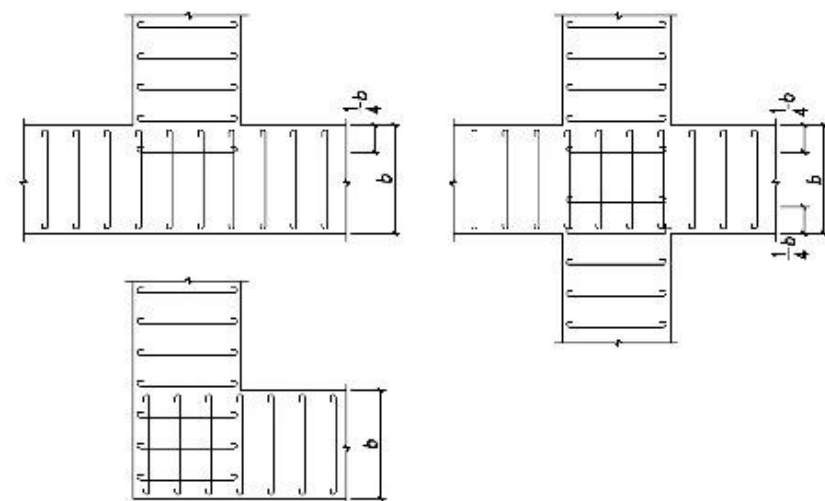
墙下条形基础纵横交叉处底板受力钢筋布置
